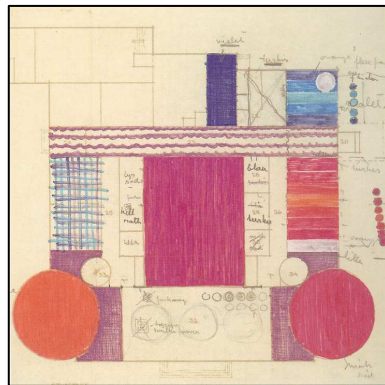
Planungsskizze, Grundriss Restaurant Varna³⁵⁴
